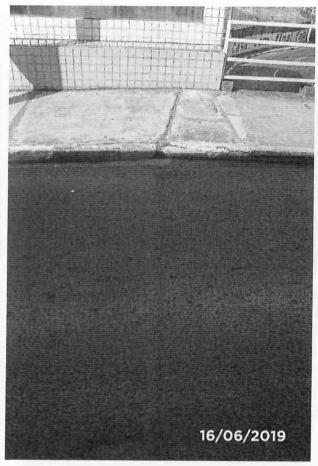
Vista da fissura no pavimento asfáltico e no passeio entre o encontro do viaduto e a via.
